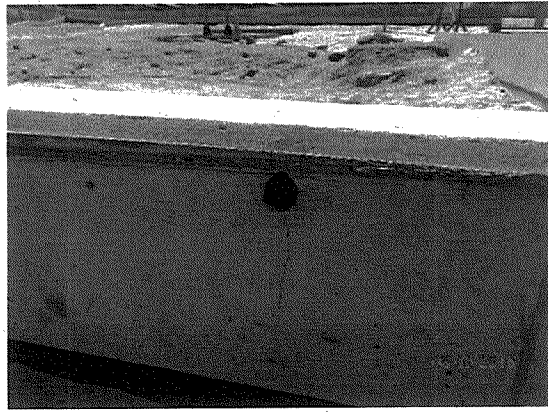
Muro de contención M1 agrietado.
